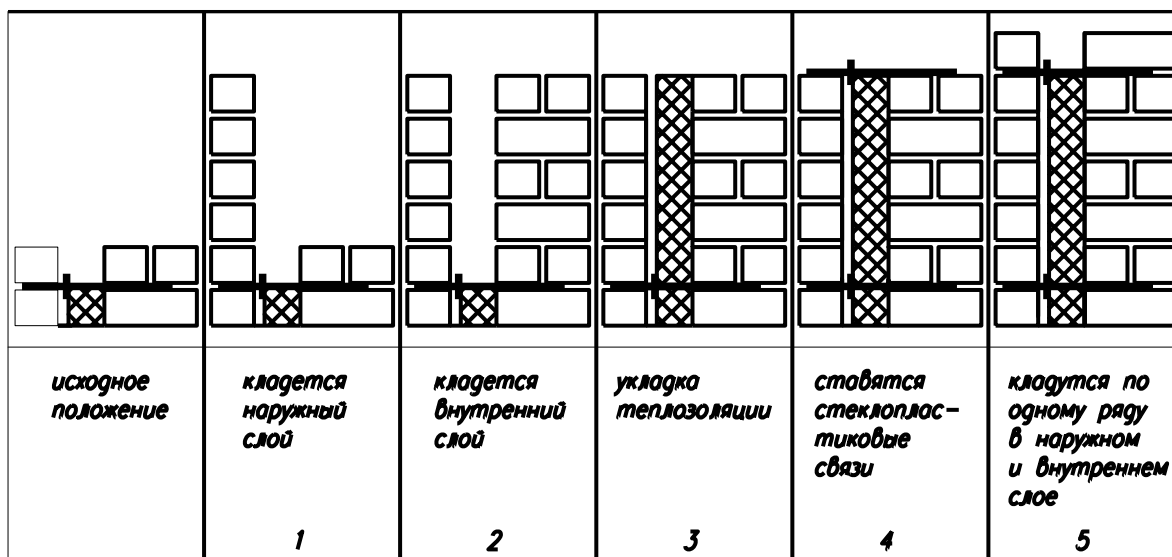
Последовательность кладки стены с теплоизоляцией из минераловатной и стекловолоконной плиты.
